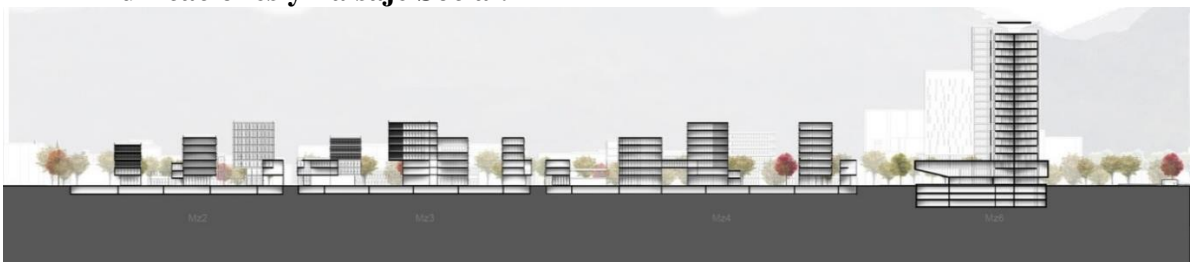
Corte General proyecto Ministerios, Fuente: Plataforma Arquitectura
